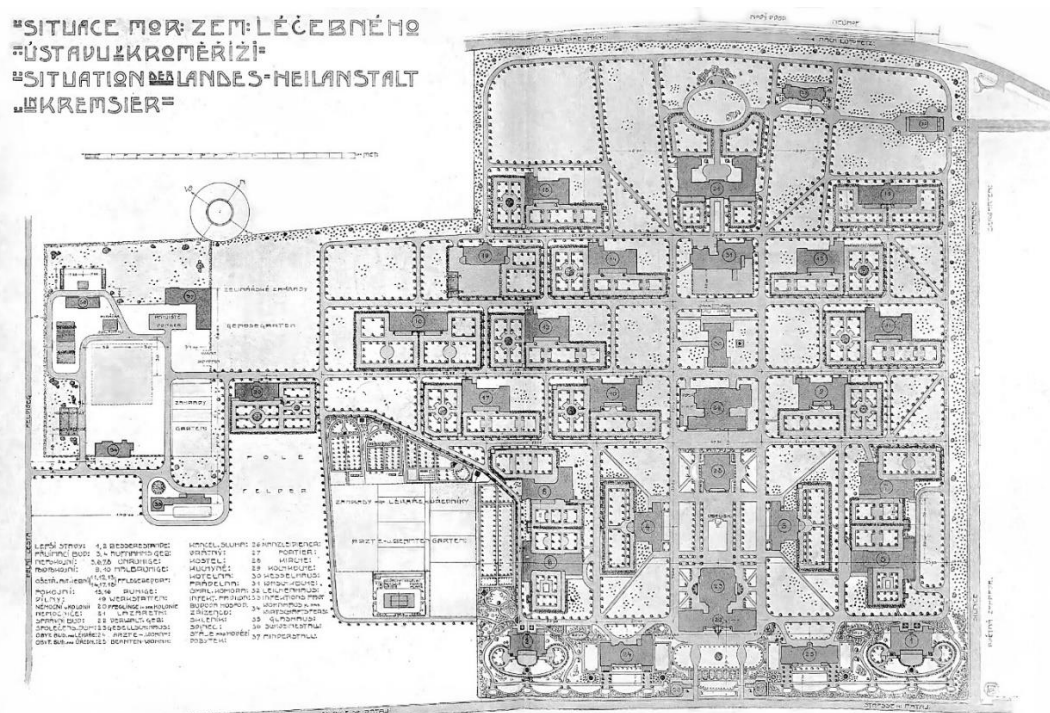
Grundriss der Landes-Heilanstalt Kremsier/Kroměříž⁵⁵³
